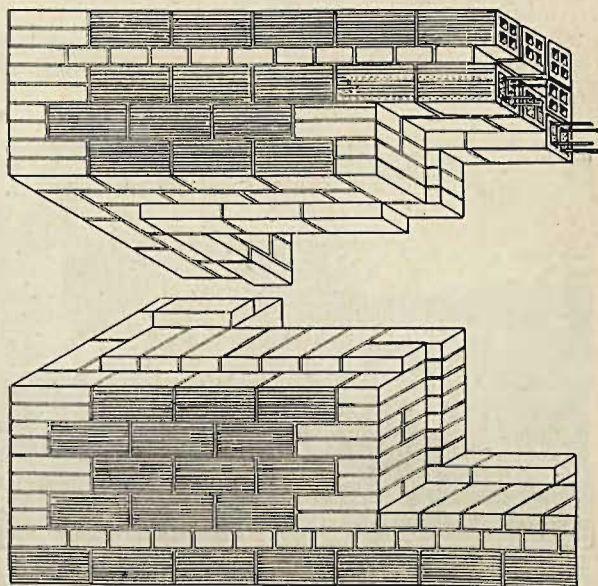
Wiązanie muru grub. 1 1/2 cegły (41 cm) z dziur. podwójnych typu III z nadprożem.
